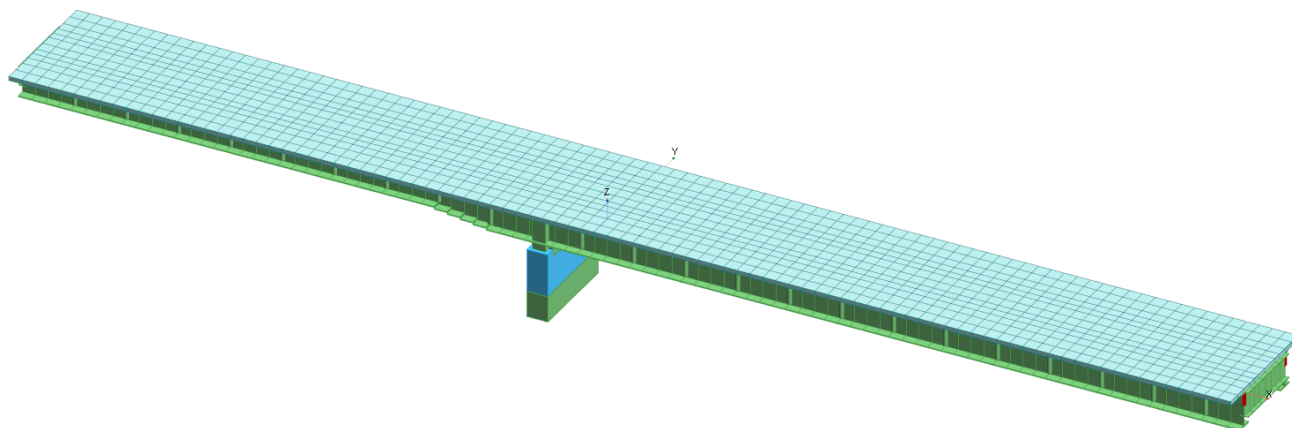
VISTA TRIDIMENSIONALE SOLIDA MODELLO – DALL'ALTO
